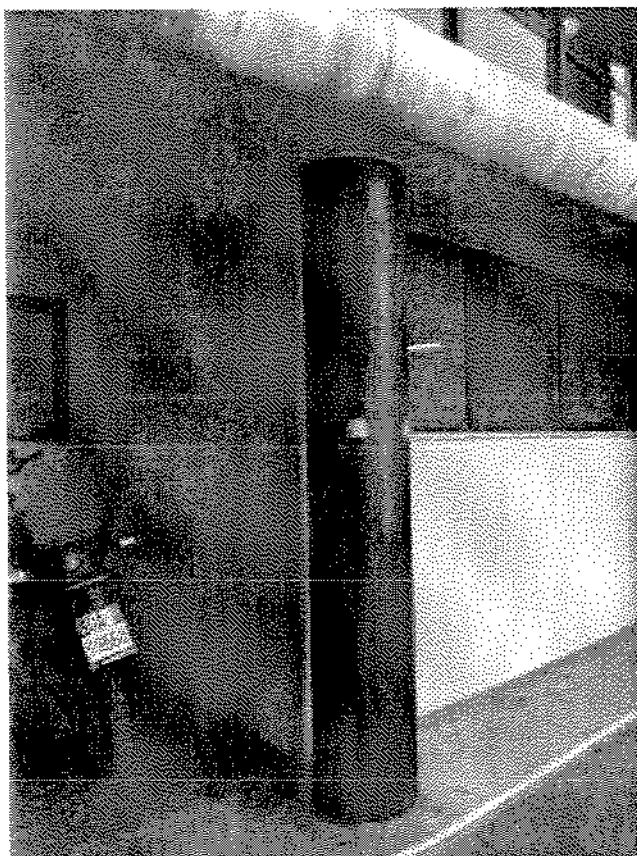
angolo dell'edificio – sul muro cieco del porticato è prevista la realizzazione del nuovo ingresso diretto alla cucina
